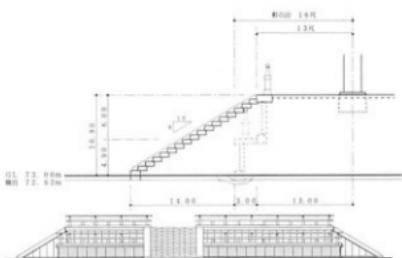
案② 階段部分断面図(1:200)・東立面図(1:500)
